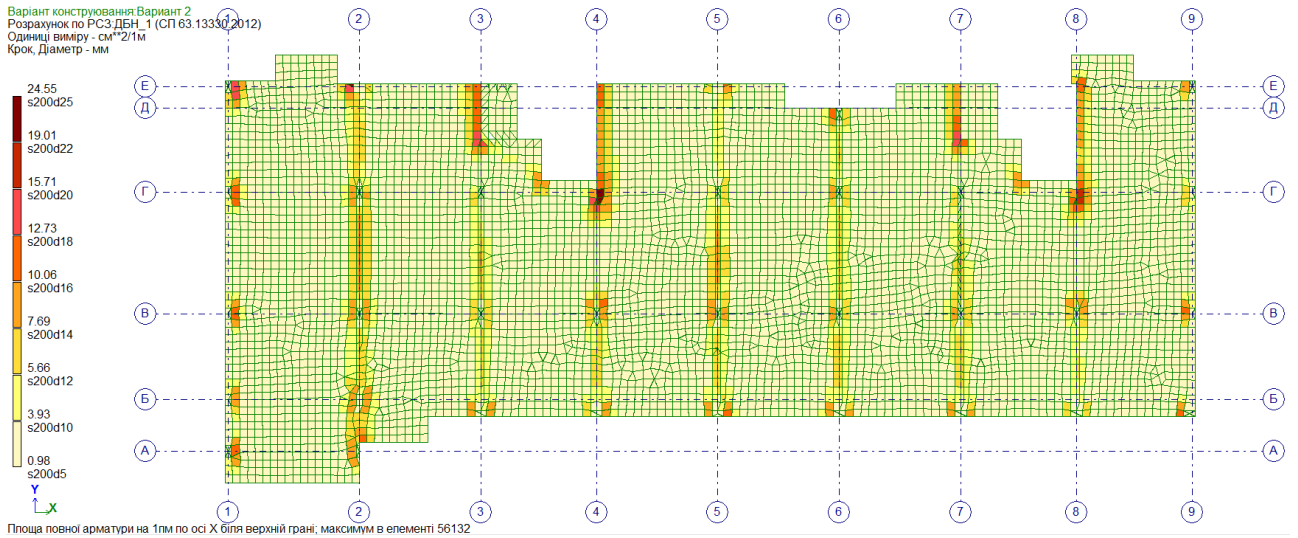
Ізополя розрахункового армування плити перекриття типового поверху. Верхня арматура вздовж осі X
